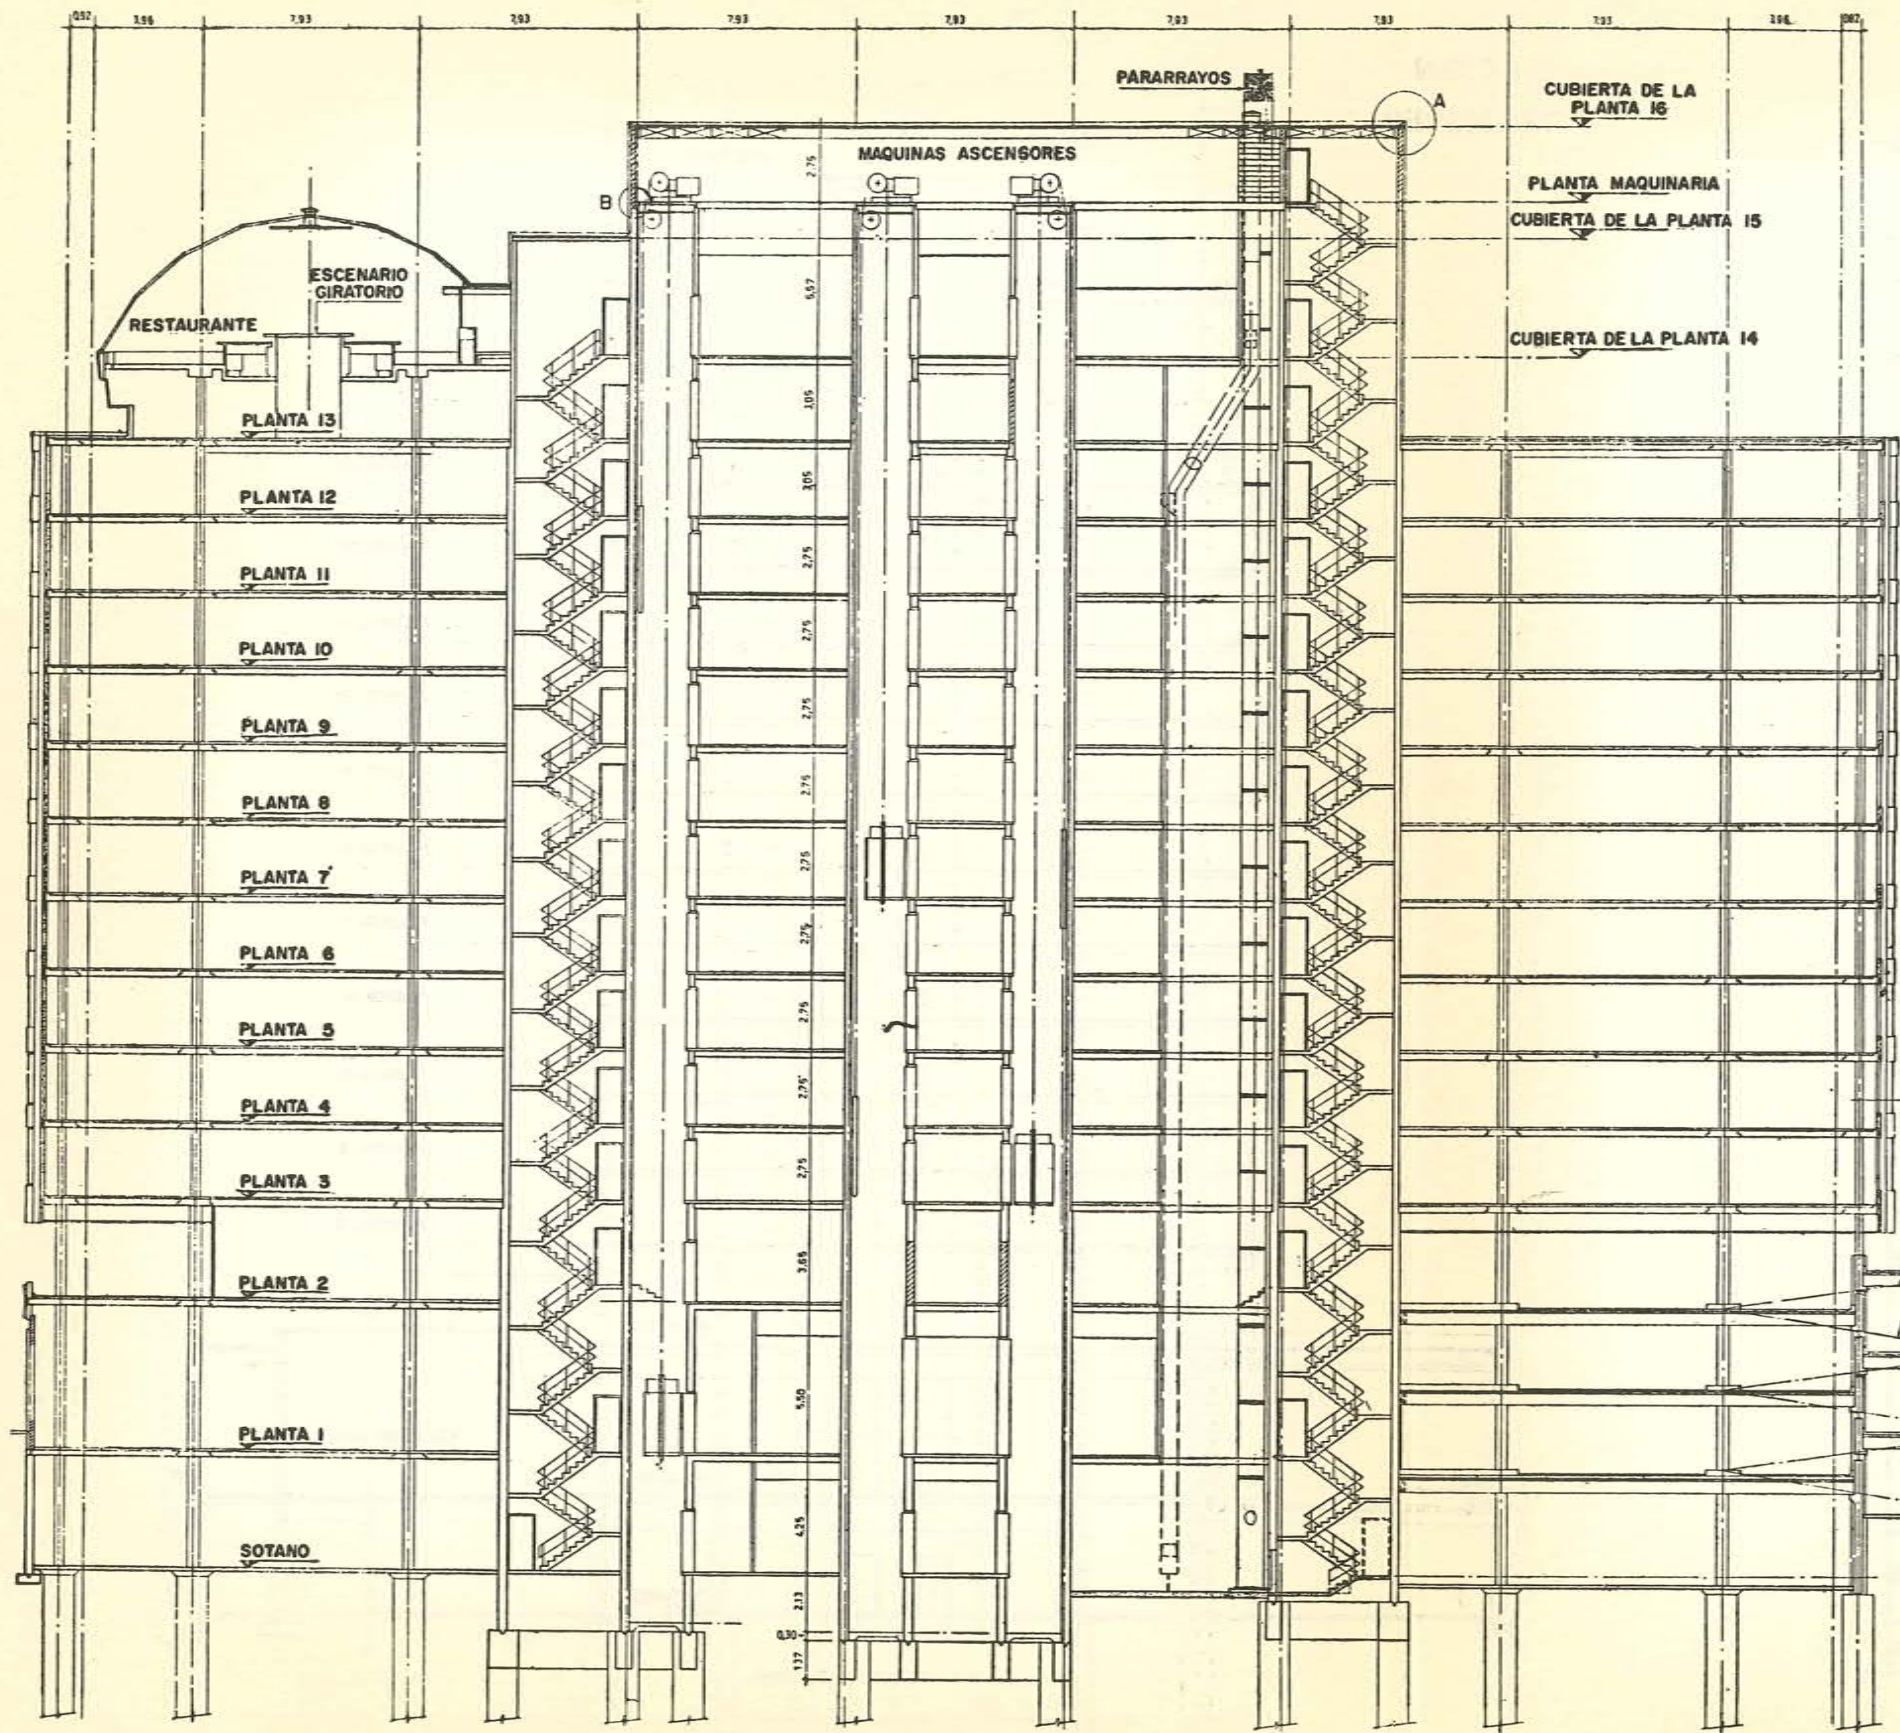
Sección de la última planta del edificio: A) cubierta, B) forjado del piso.
